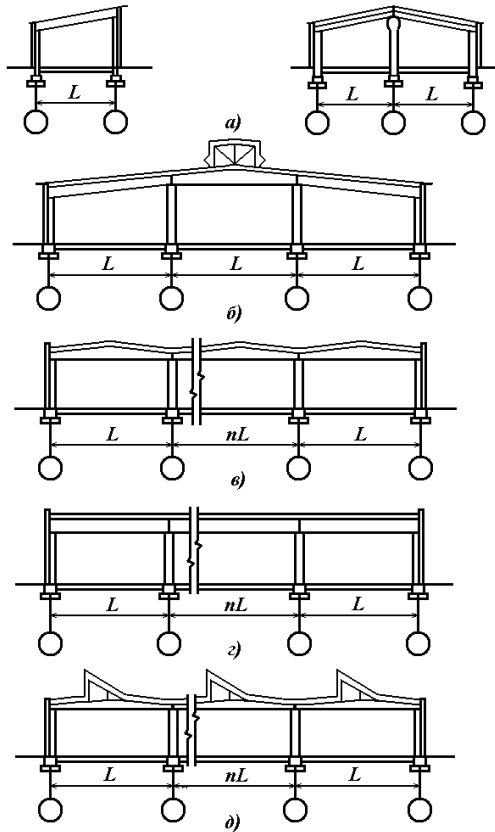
Основні типи одноповерхових безкранових будівель (поперечні розрізи):
